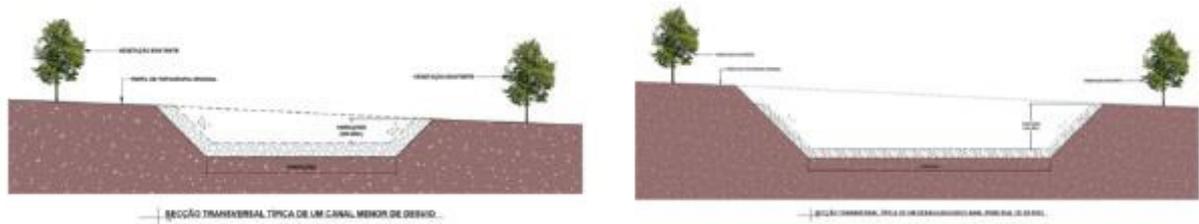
Perfis transversais dos Canais de desvio, Fonte: Plano de Lavra Anexo II – 28
